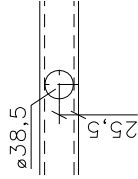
### DETAIL PRŮBĚŽNÉHO SLOUPKU
